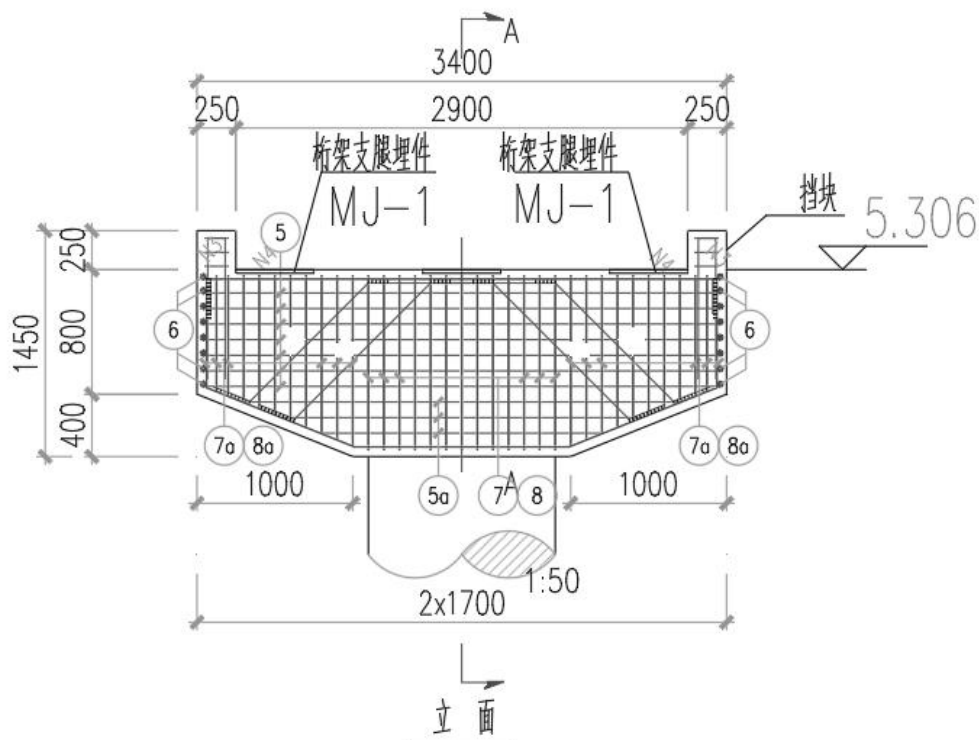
三八河东侧支流内管廊支架支墩立面图
